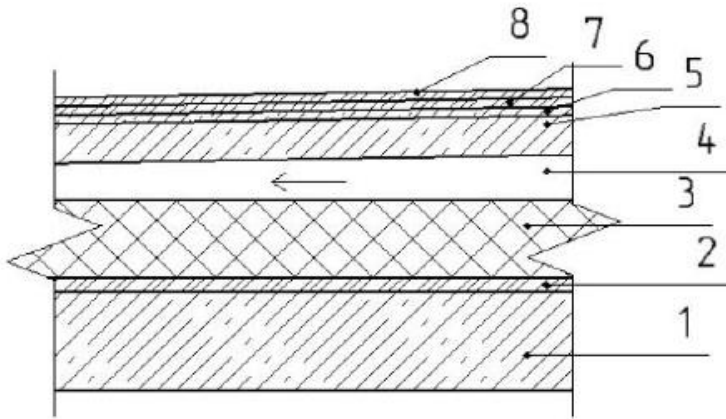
Вентильована експлуатованим покрівля:
